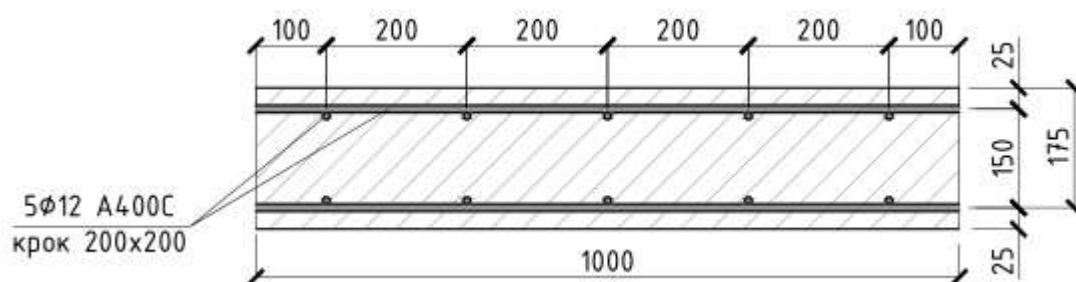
Верхня розкладка арматури по всій площі плити.
